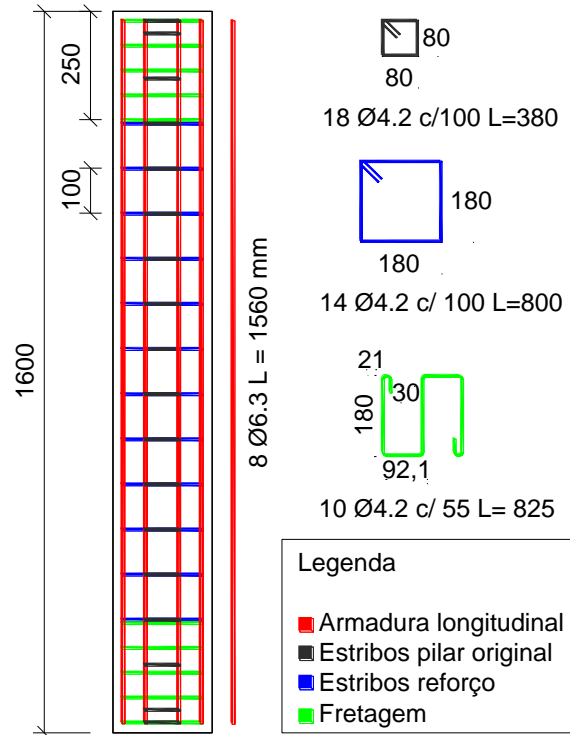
Detalhamento da armadura do pilar PR_R
